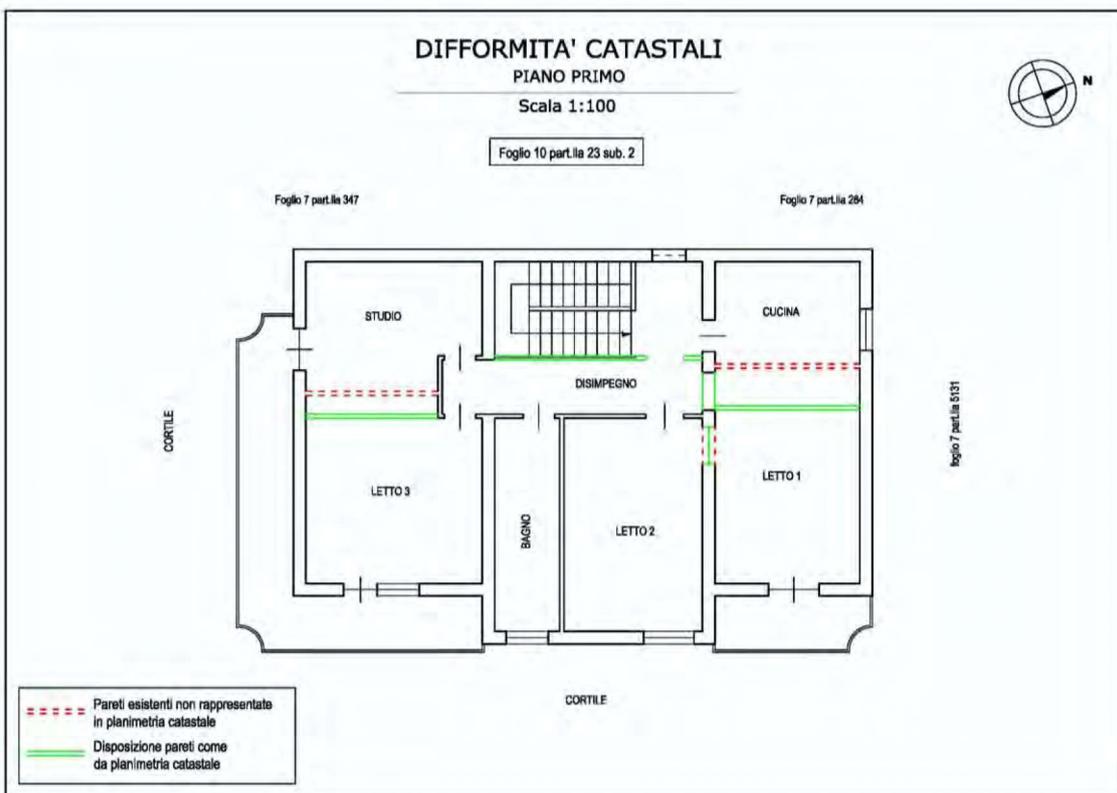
Rappresentazione difformità catastali fabbricato – piano primo
